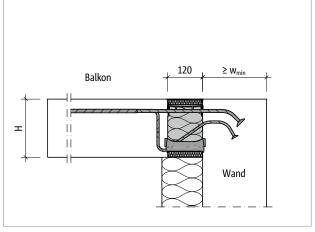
Schöck Isokorb® XT Typ K-O: Wandanschluss nach unten bei Außendämmung
